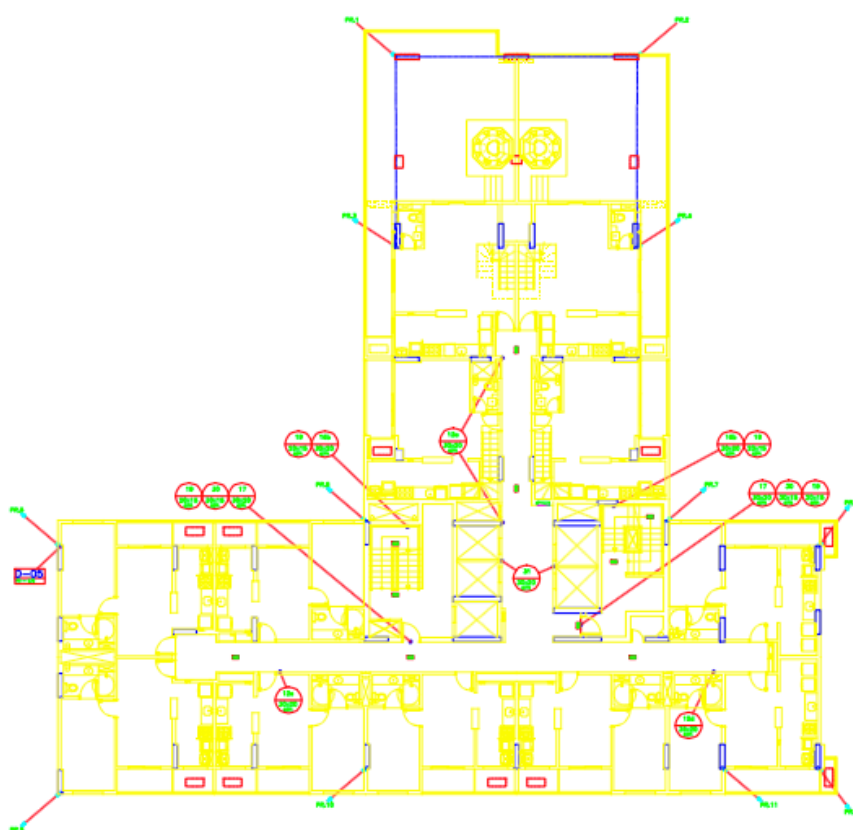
Sugestão de reformulação de projeto para pavimentos com terraço descoberto
